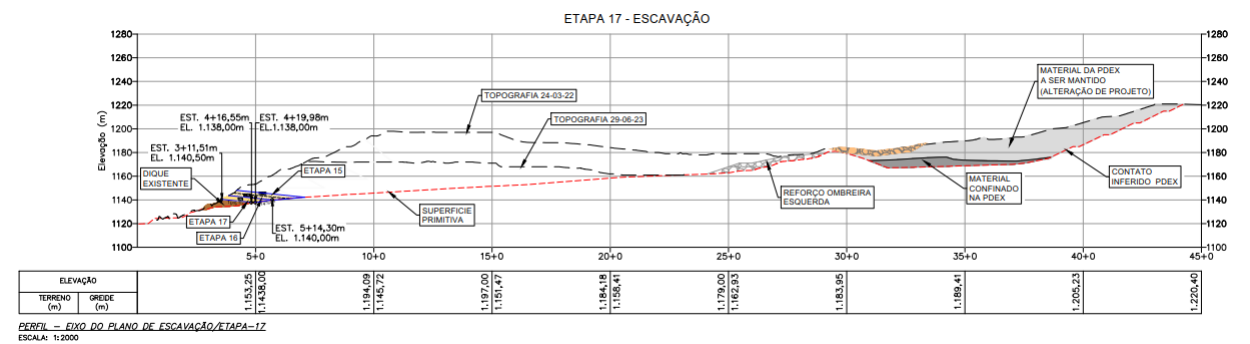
Perfil de escavações – etapa 17 de projeto (1850MZ-X-000346)
